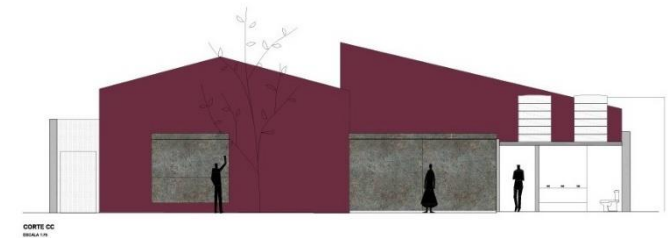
y 88 – Plano y sección longitudinal. (Fuente: AR-Arquitectos)
